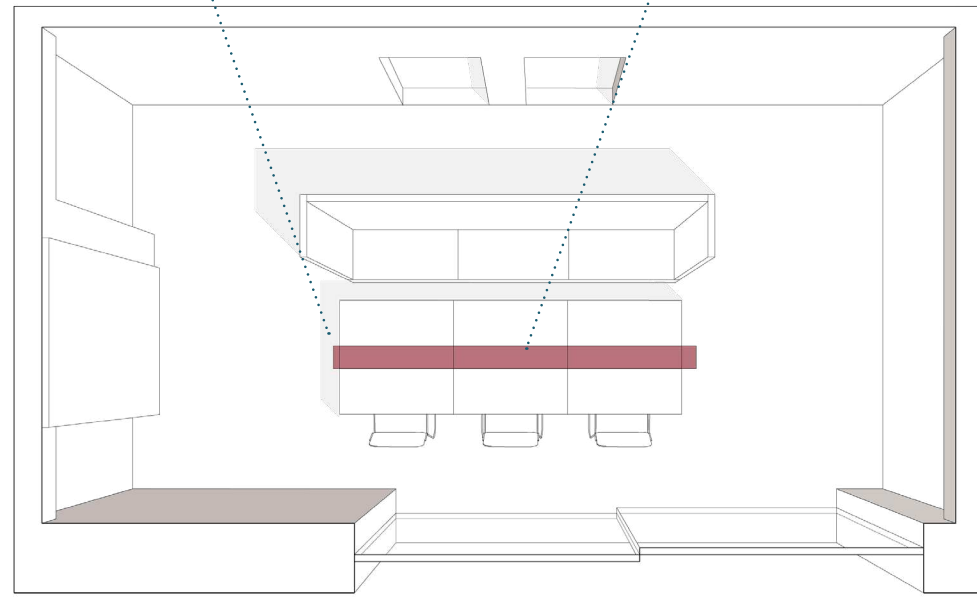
Grundriss - Kommunikationsbereich
